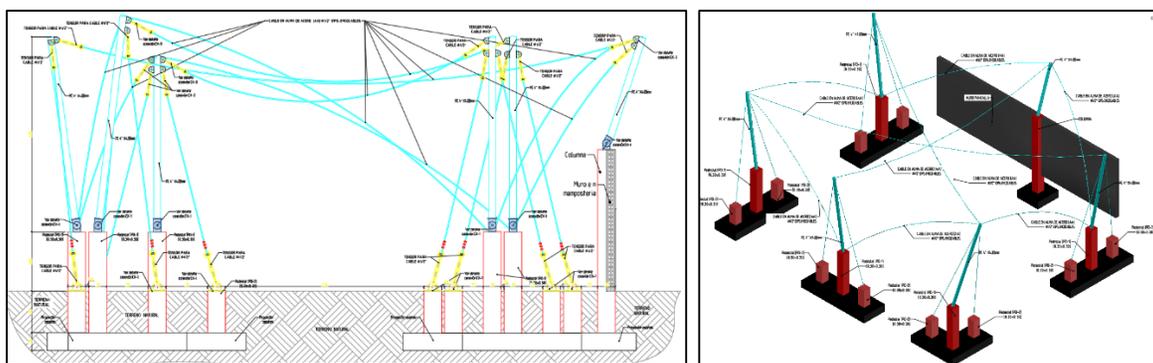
Diseño Estructural Cubierta en Membrana Arquitectónica Auditorio
